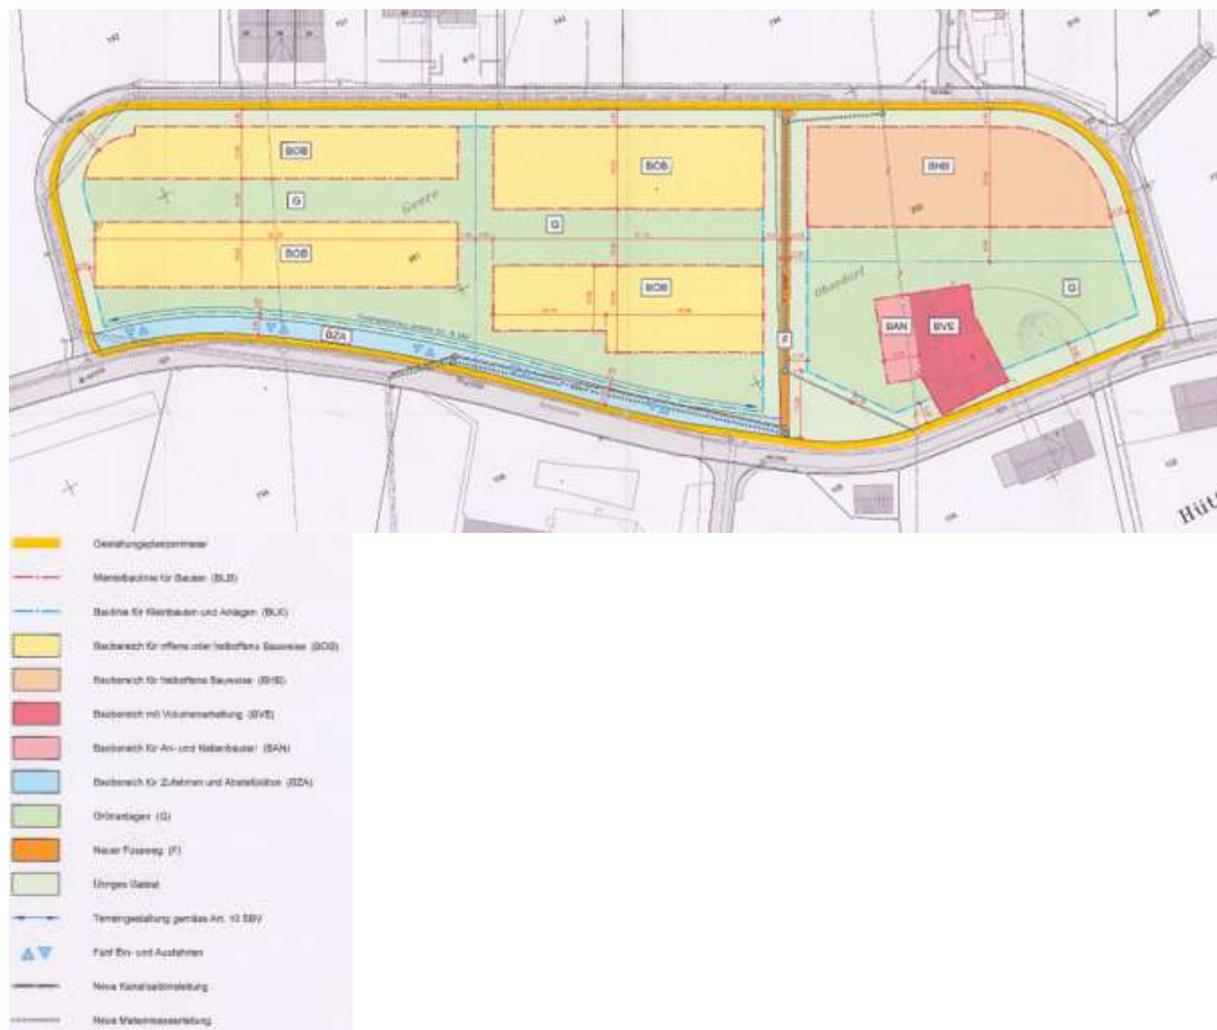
Ausschnitt Gestaltungsplan Geeren Süd
